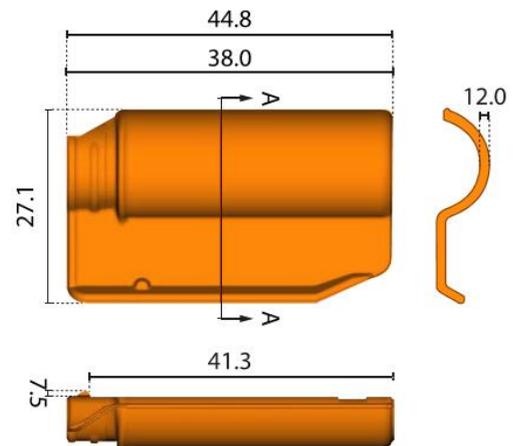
Sistema de cobertura composto por estrutura metálica, telhas cerâmicas compostas de encaixe modelo americana e forro de PVC rígido
